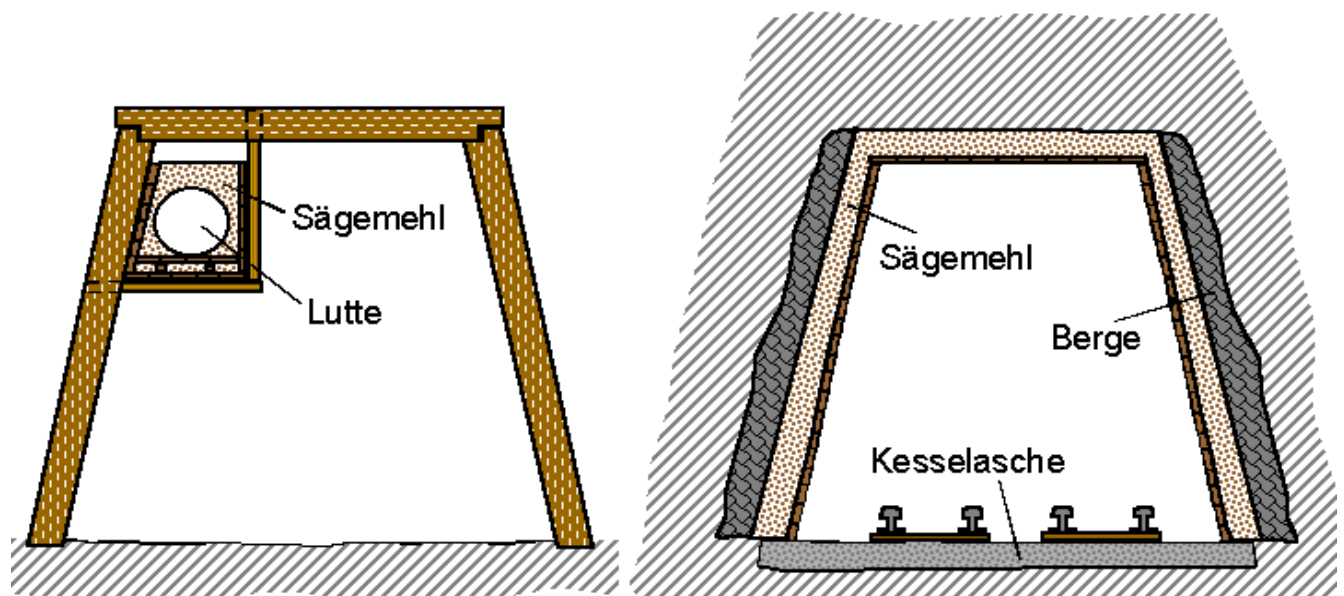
Isolierung einer Wetterlutte sowie einer Richtstrecke mit Sägemehl
